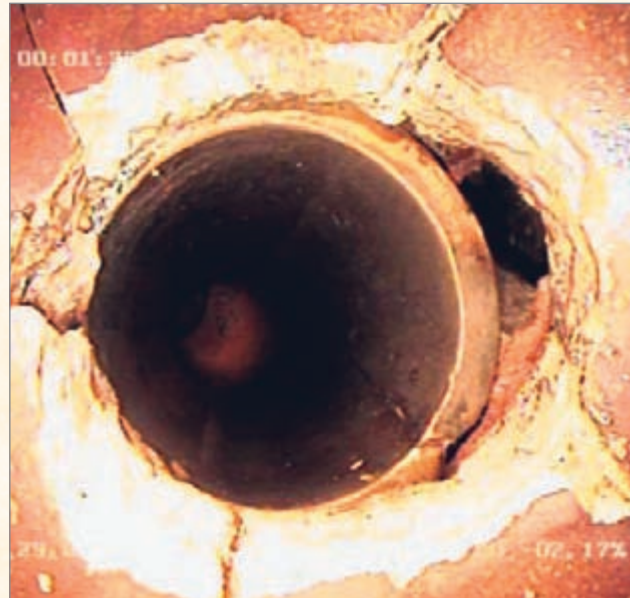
Stutzen einer Hausanschlusbleitung vor der Sanierung
